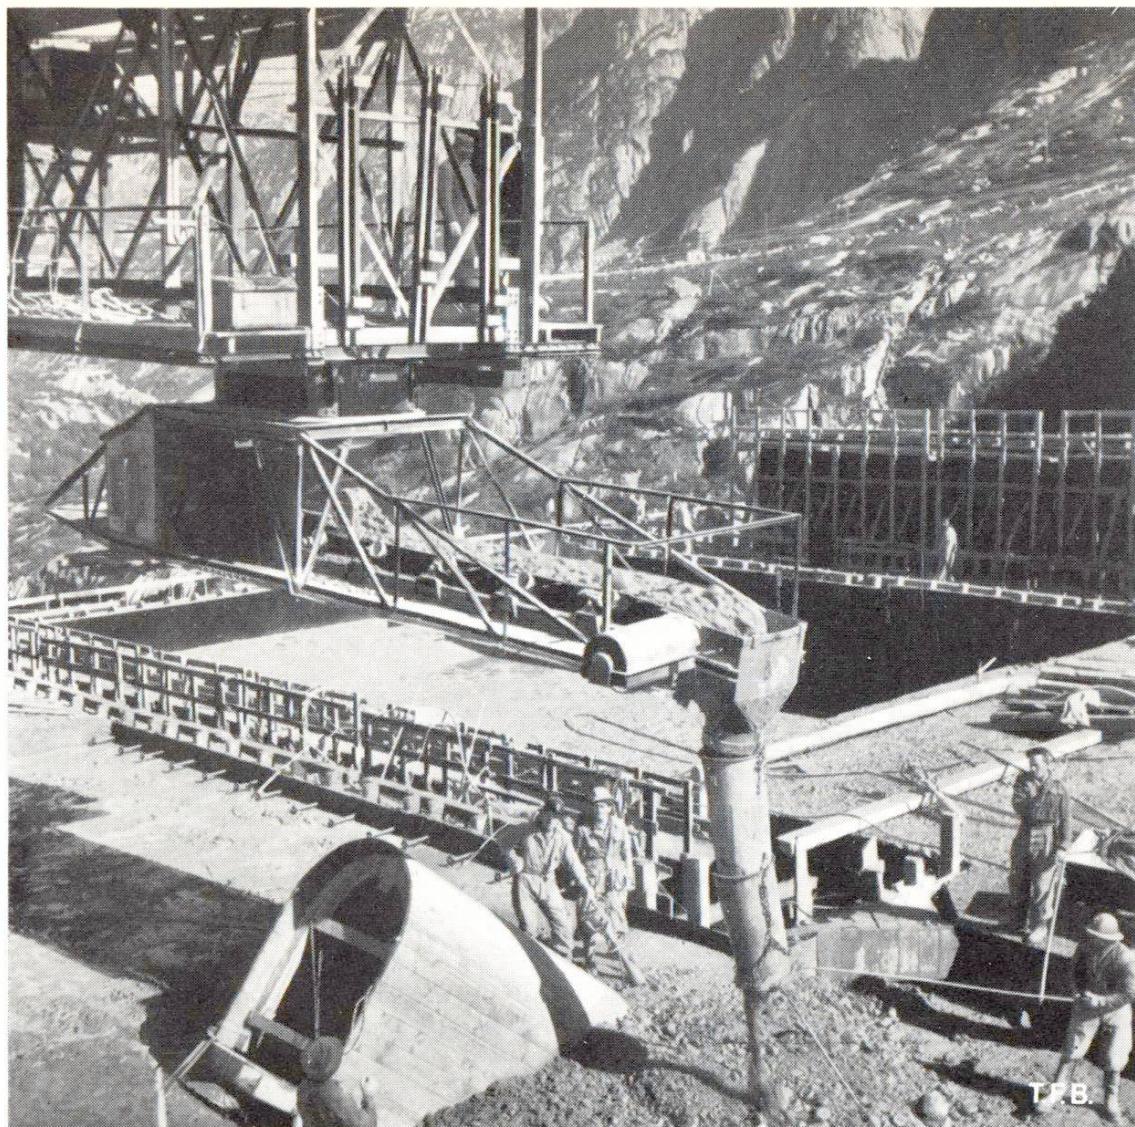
Plancher de bétonnage. Au premier plan, vibrateur manoeuvré par deux hommes
